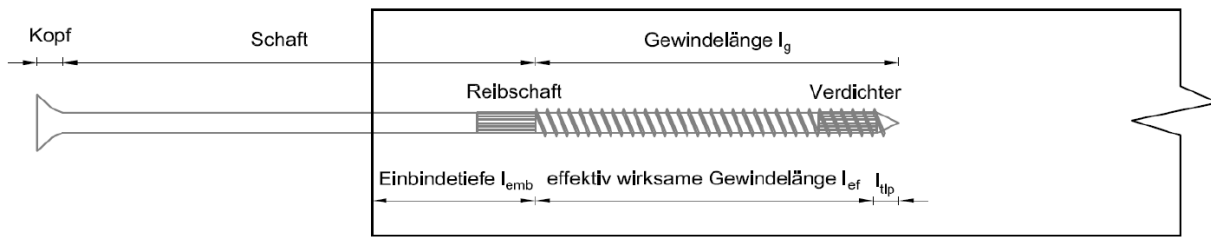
Bezeichnungen der Schraubengeometrie anhand einer in einem Holzbauteil eingedrehten Holzbauschraube aus [26]
